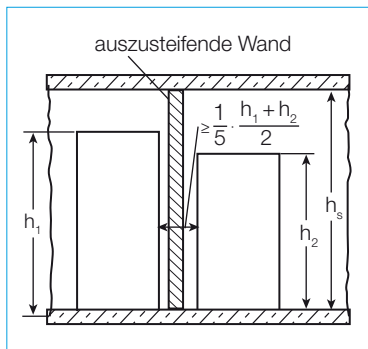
Mindestlänge der aussteifenden Wand gemäß DIN 1053-1 [63.1]
